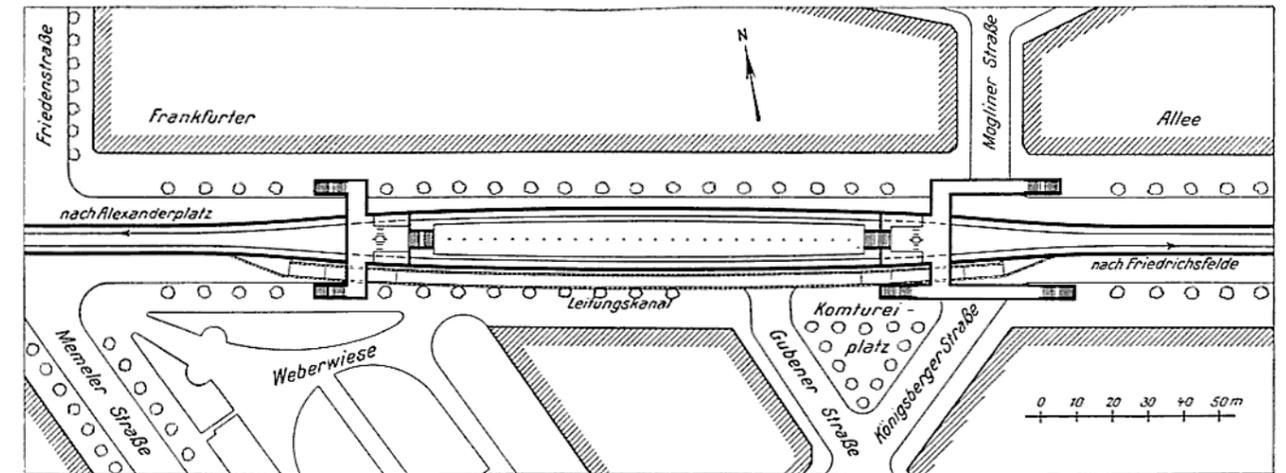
Bahnhof Memeler Straße (Linie E), Lageplan.
